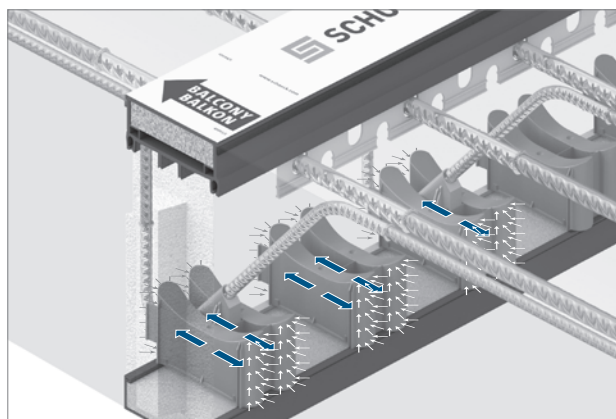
Schöck Isokorb® T тип KL: Подготовка на кофража и арматурката за бетонирането. Фуга за бетониране на стената = долен ръб на кофража на балкона!
